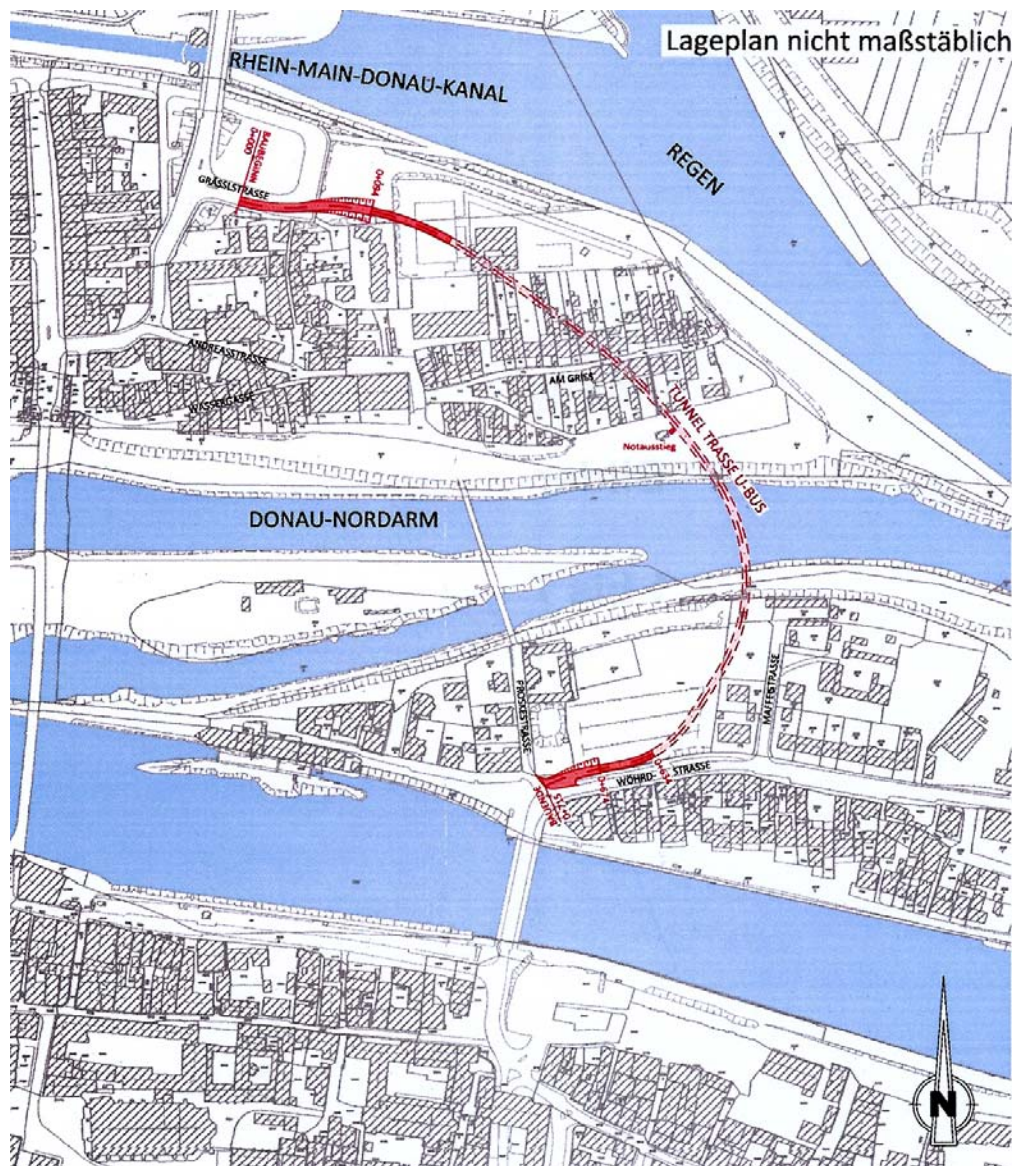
Lageplan des geplanten Bustunnels (Quelle: Machbarkeitsstudie)
